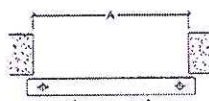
Detalle en planta de puerta industrial corrediza apoyada
